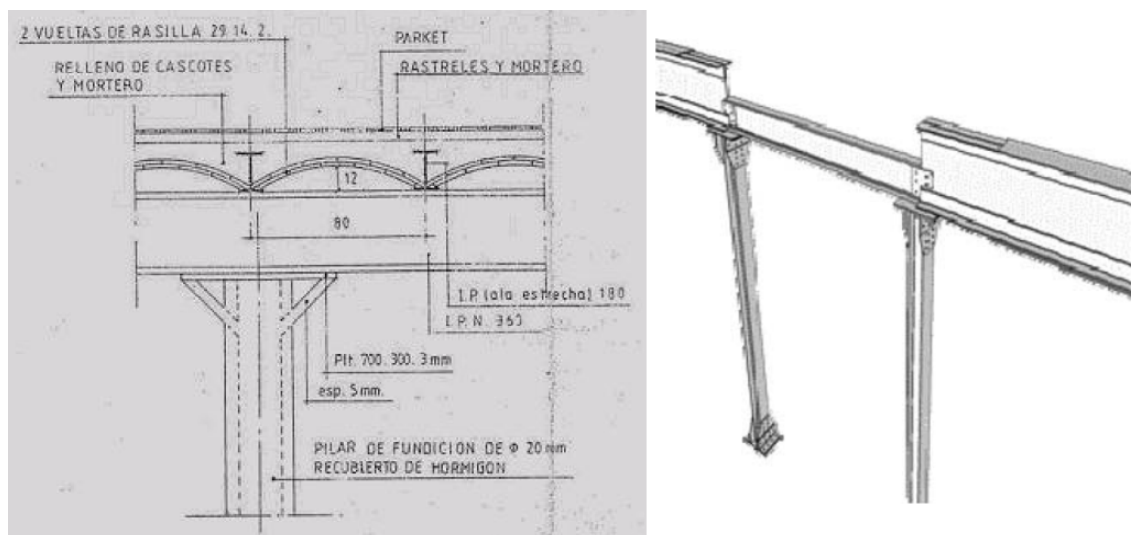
3 Forjado de vigueta metálica y bovedilla cerámica de planos originales (izquierda)(Moreno 2012). Detalle de una viga metálica apoyada sobre una columna de hierro (derecha)(Avila-Haro et al., 2016)
